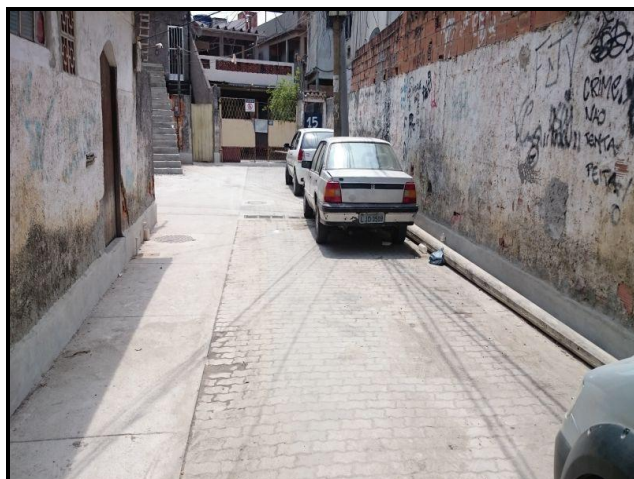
Estrada do Guerengê nº 21, beco 16 A, término da pavimentação em blocos intertravados e concreto, concluído.
